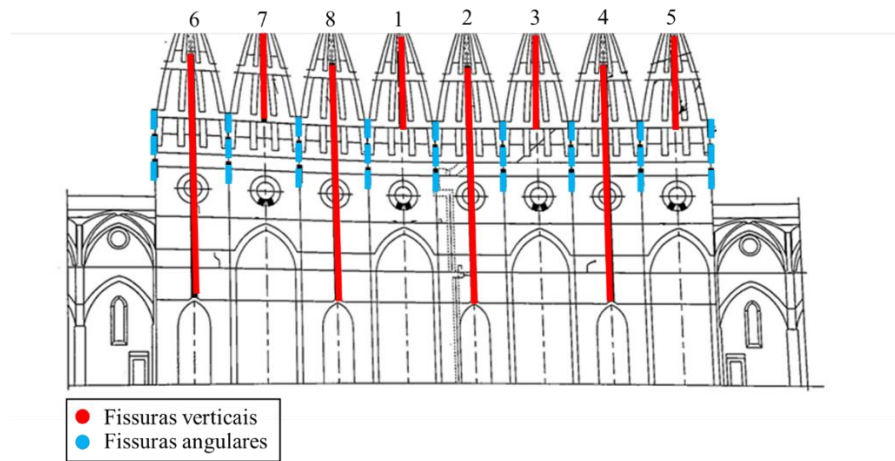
Representação planificada das fissuras angulares e verticais na estrutura da cúpula e sua base de sustentação na Catedral de Santa Maria del Fiore (Fanelli & Fanelli, 2004, adaptado)
